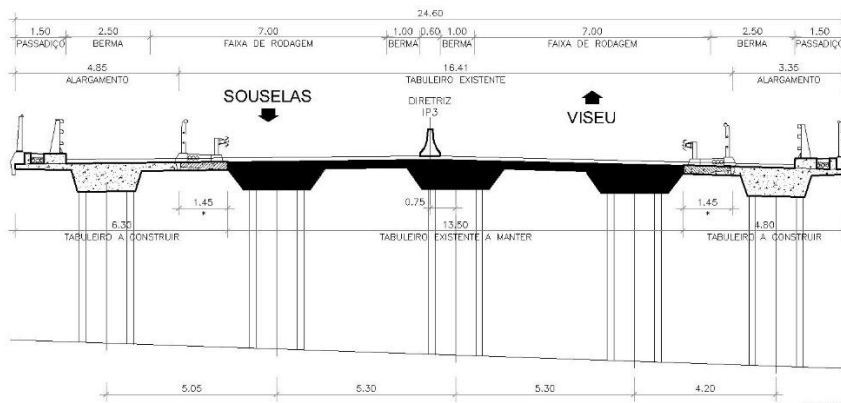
Corte transversal da ponte sobre a ribeira do Lobão
